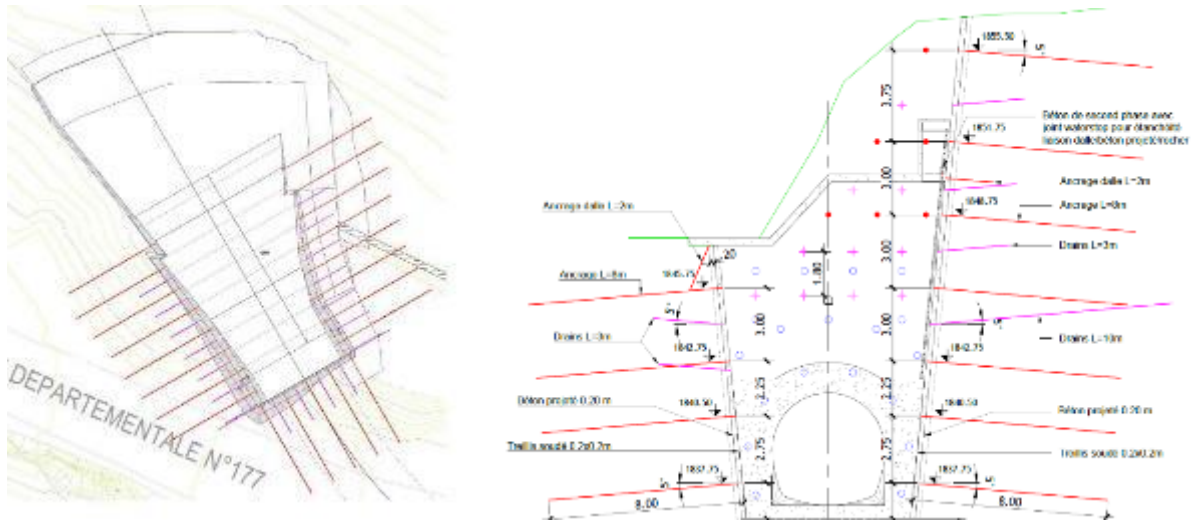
Ouvrage d'entonnement – vue des excavations avec dispositifs de soutènements
